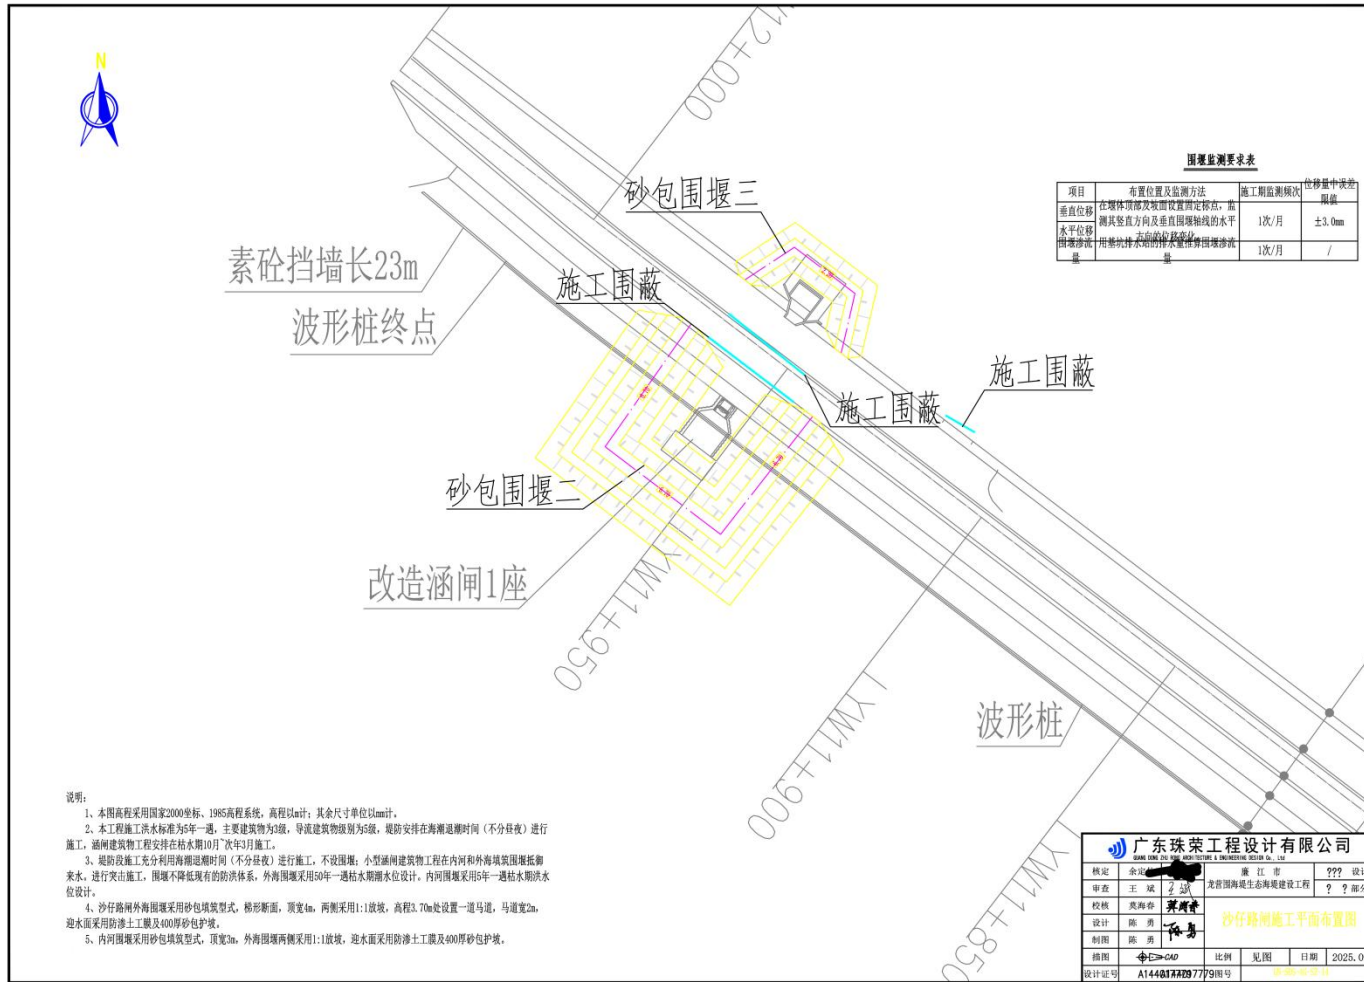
沙仔路闸施工平面布置图（施工期围堰平面布置）
